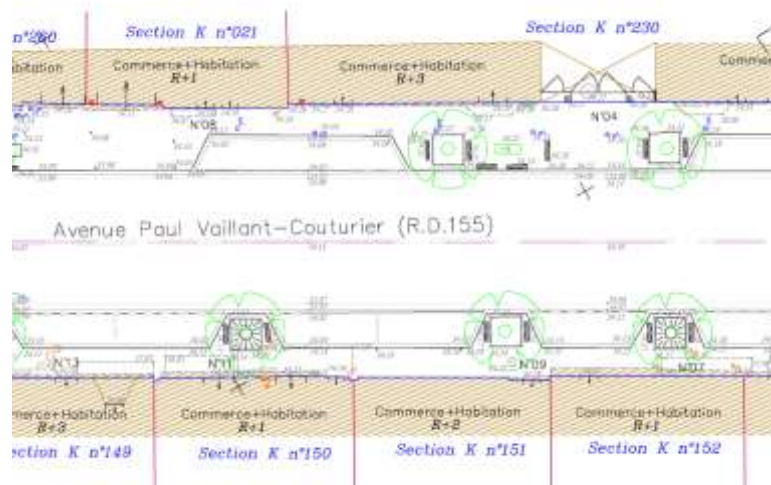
Extrait du plan topographique de l'avenue Paul Vaillant Couturier, Vitry-sur-Seine
